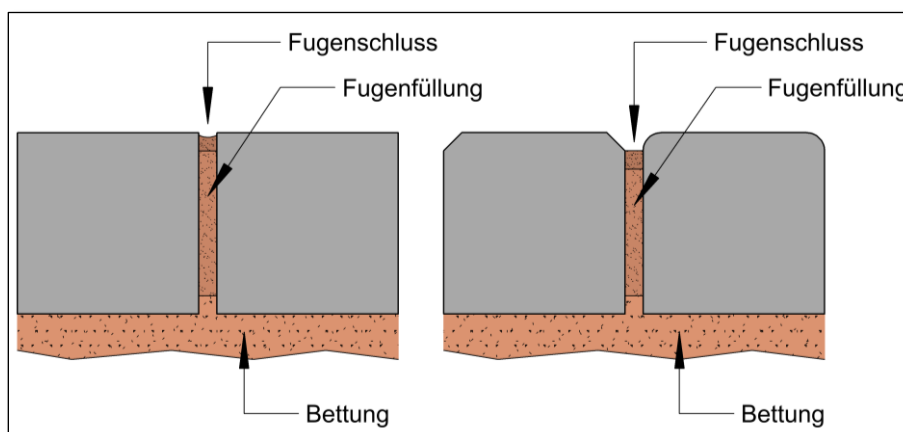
Fugenfüllung einschließlich Fugenschluss bei einer Pflasterdecke (Zeichnung: SLG)
